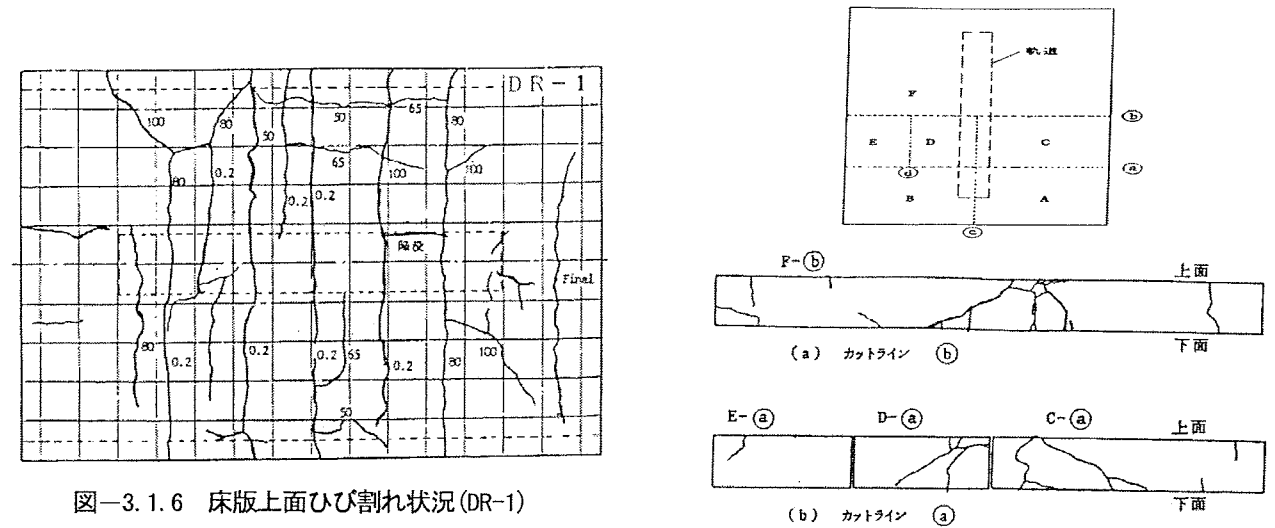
床版上面ひび割れ状況(DR-1)
